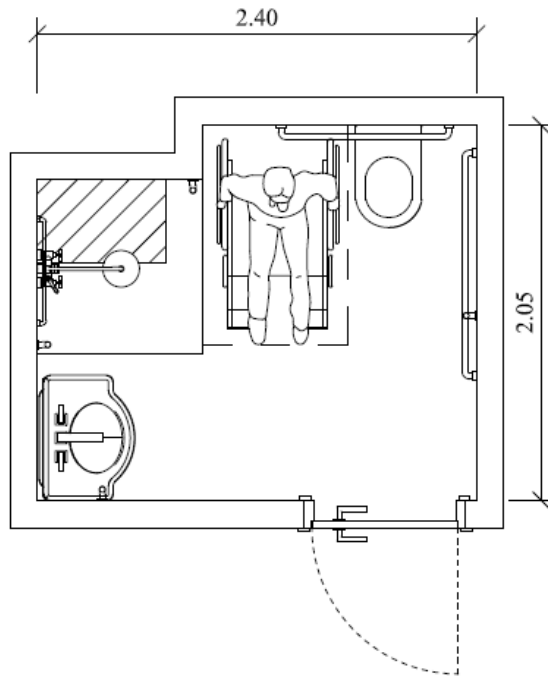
Planta baixa de um banheiro acessível. Fonte: Produzido pela autora.
